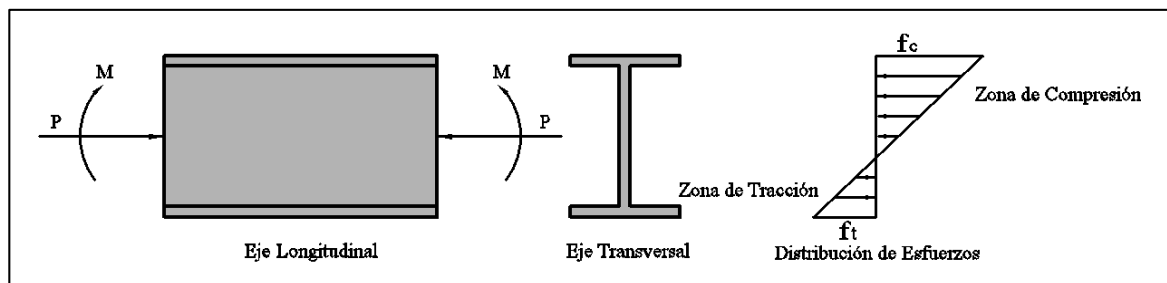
Zona Comprimida y Traccionada en la Columna.
